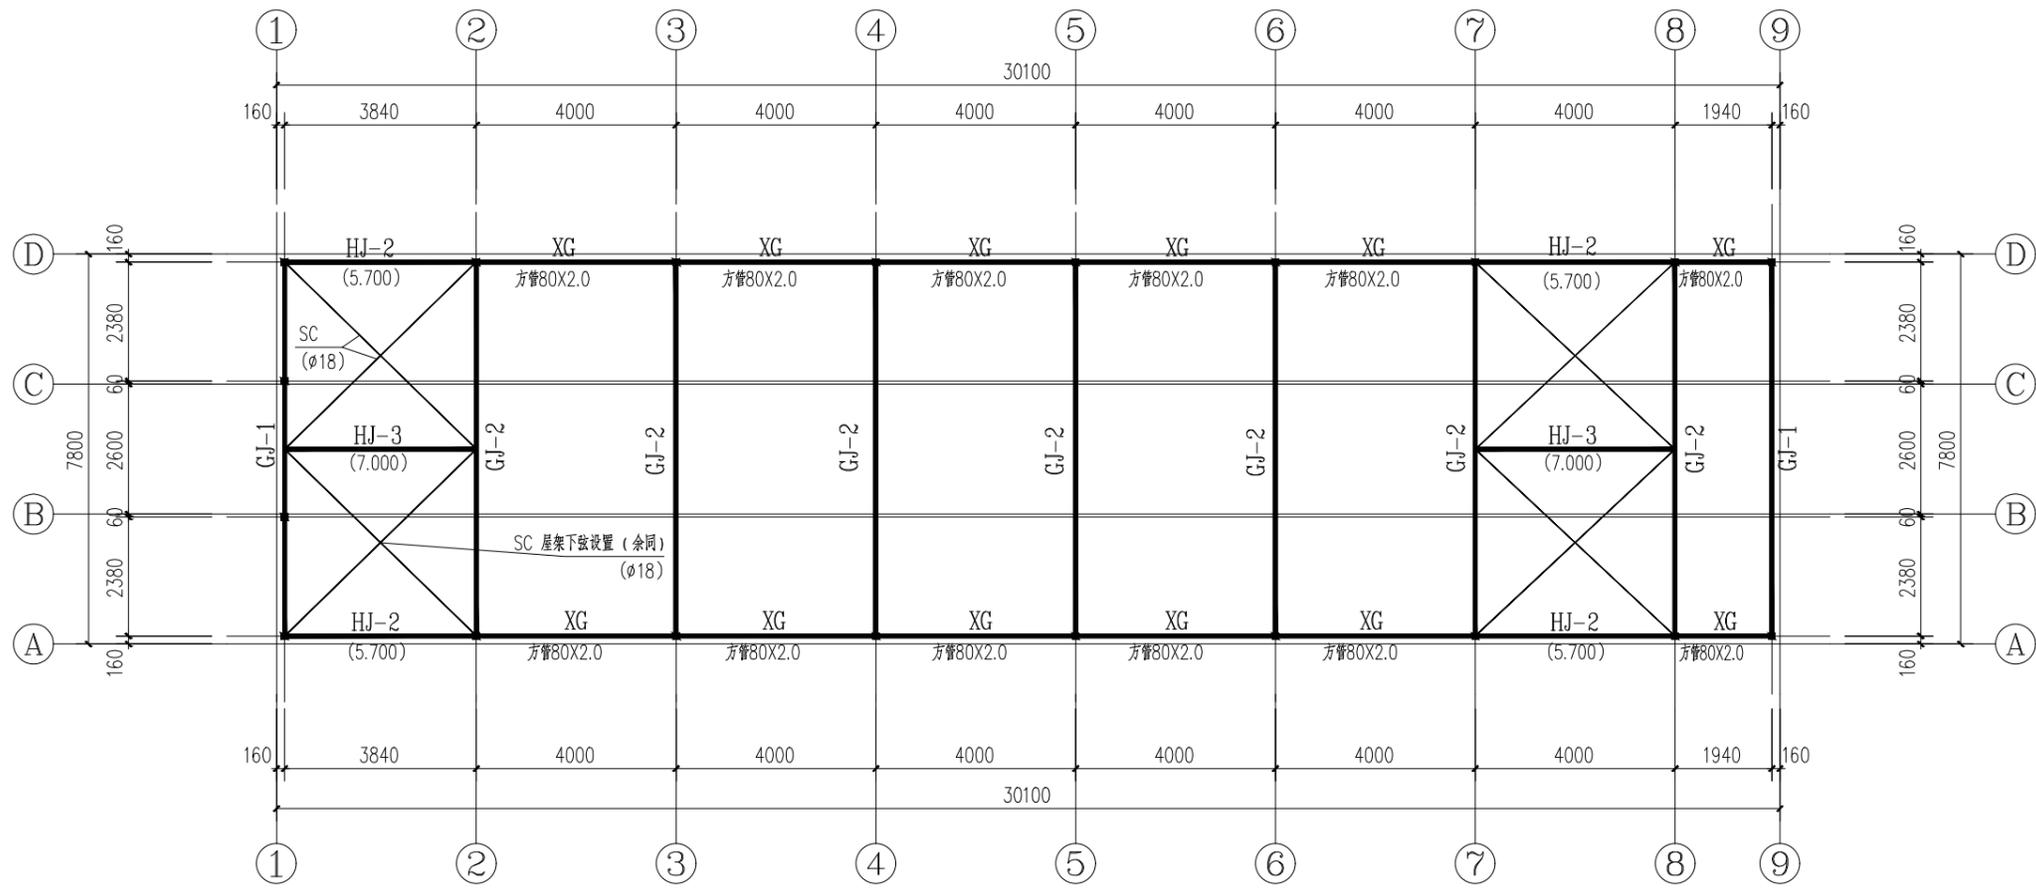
米长廊房 钢柱及柱间支撑平面布置图
